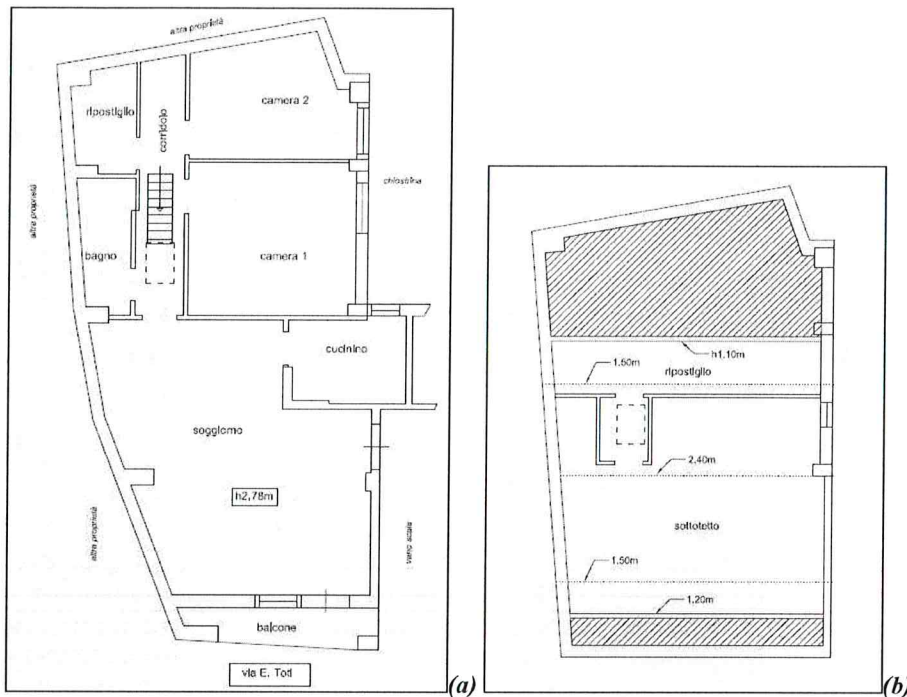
Planimetrie attuali dell'appartamento ubicato in via Enrico Toti n° 2A – Scala B interno 3: piano secondo (a); piano terzo sottotetto (b).
